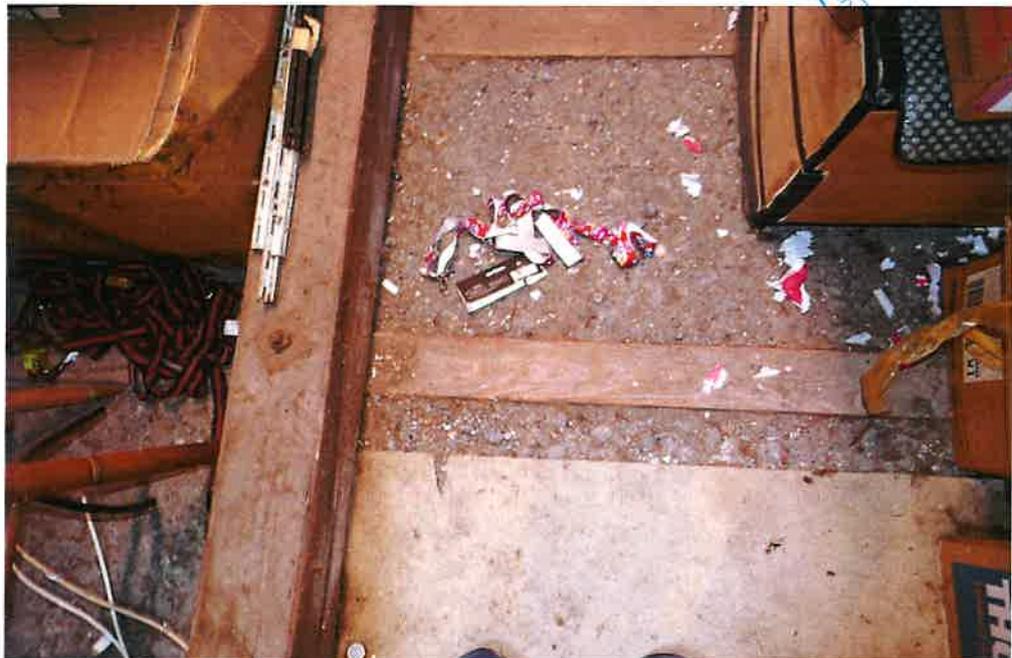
Wärmedämmung im Dachboden fehlt, gemäß GEG nachzurüsten
